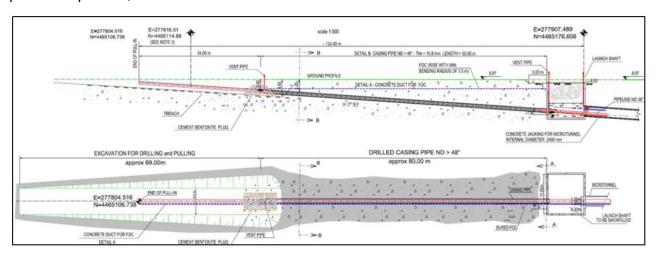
Sezione e pianta del tubo camicia di protezione (Fonte: SAIPEM 2016).
